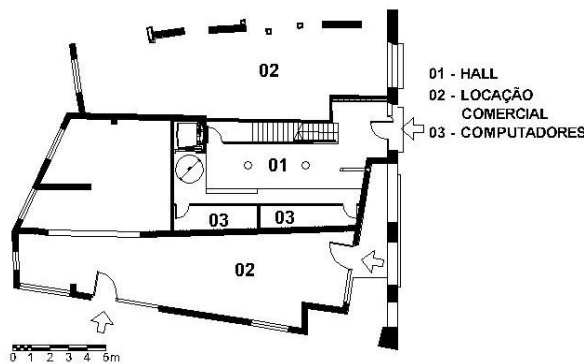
Planta Térrea da Habitação de Proteção Oficial Giralt el Pellisser
